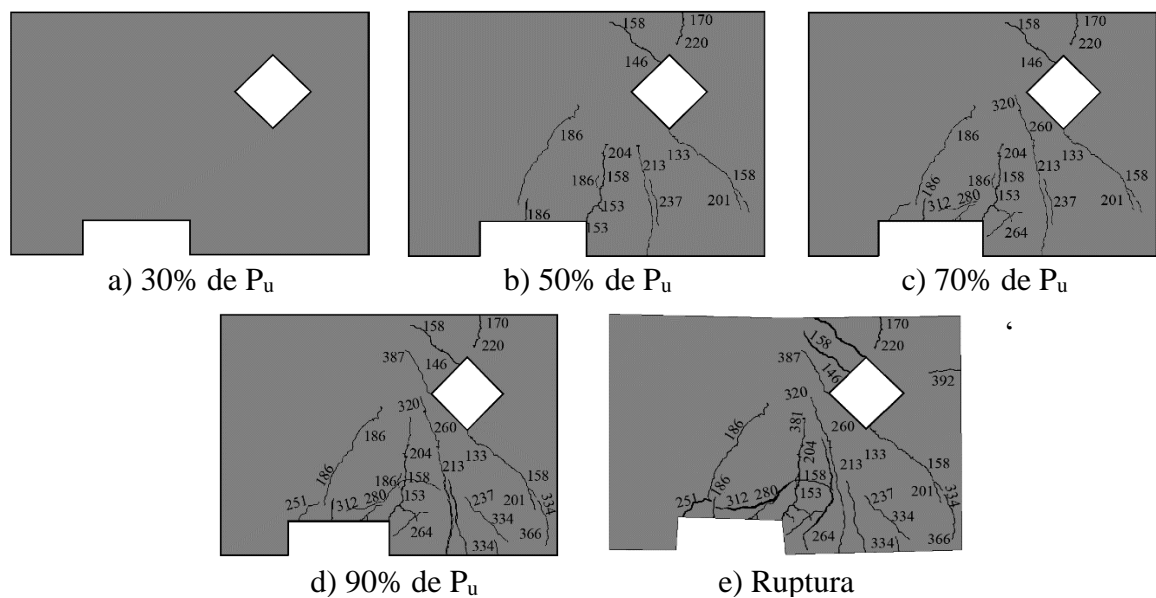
Mapa de fissuração DB3-W-H1-U-1 (força indicada em kN)
